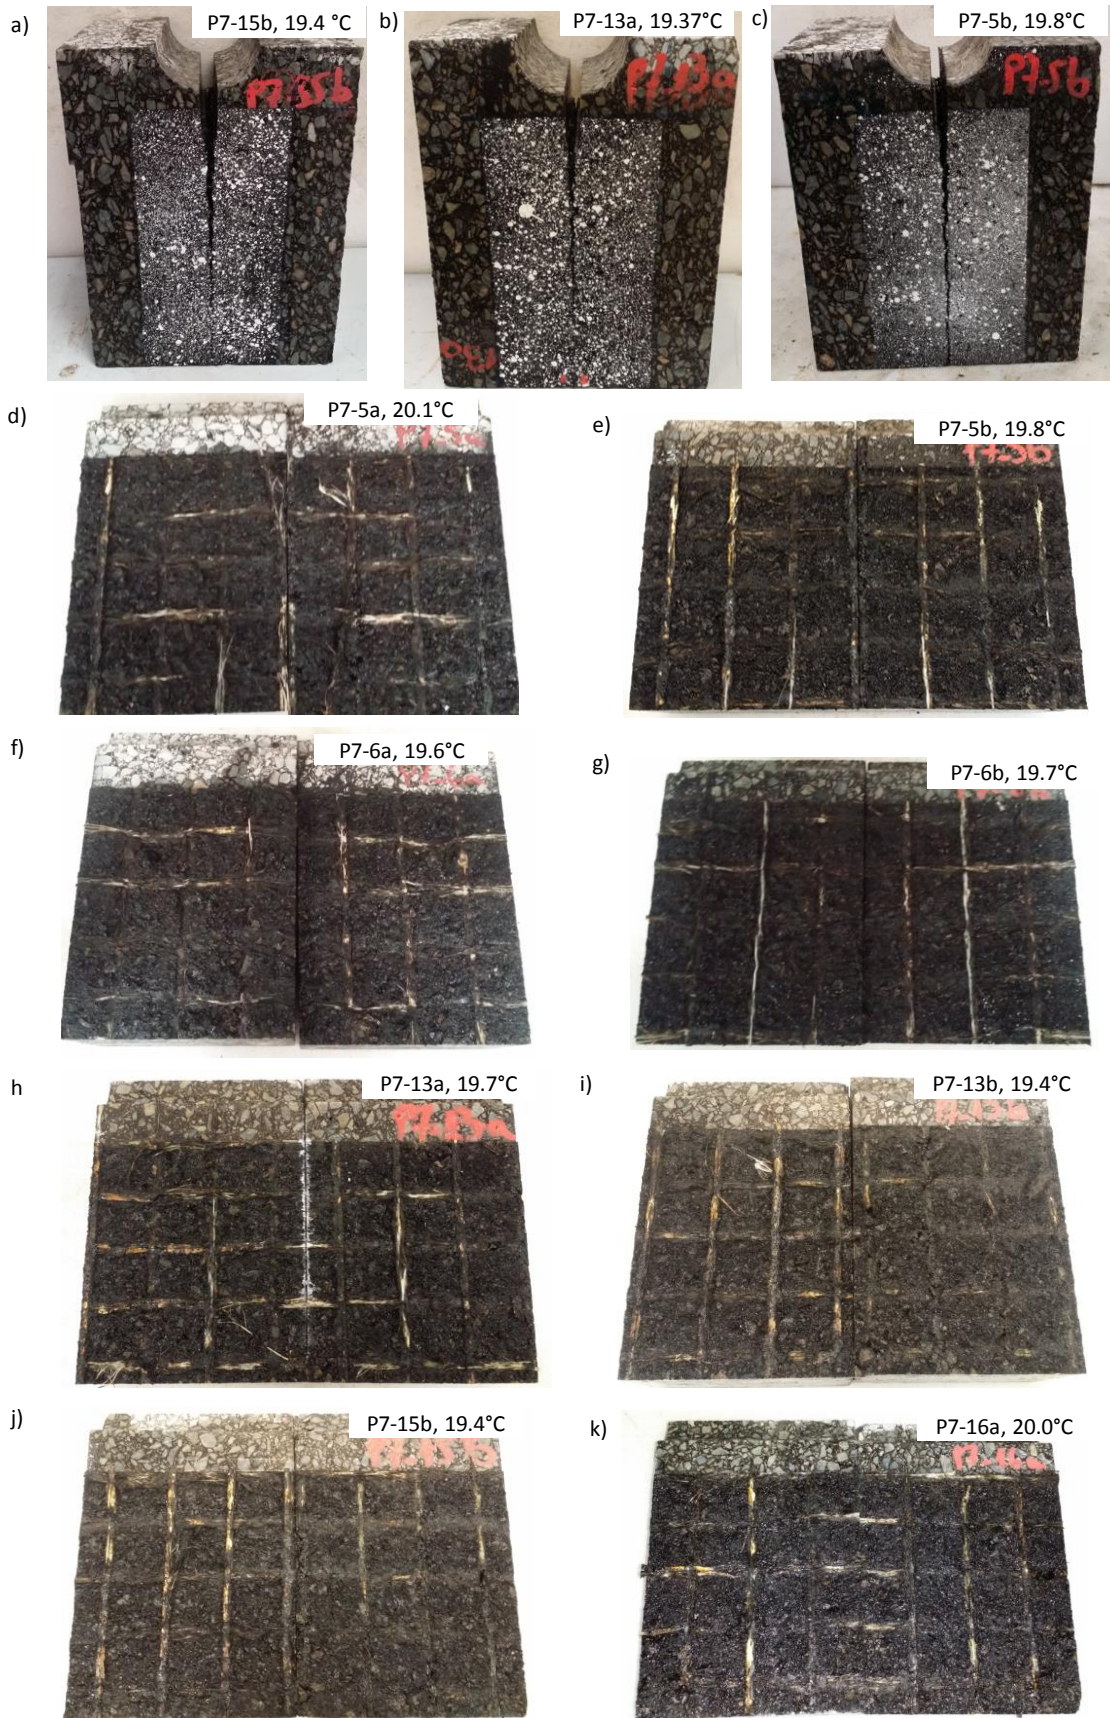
Surfaces de ruptures des éprouvettes P7 renforcées par la grille G4 testées à 20°C sous eau
